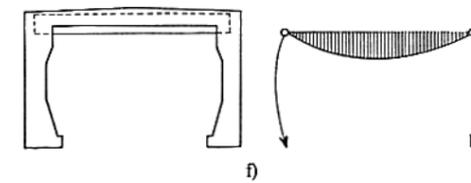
Tunnelwände reiner Stampfbeton. Decke I-Träger, dazwischen Betonkappen.
